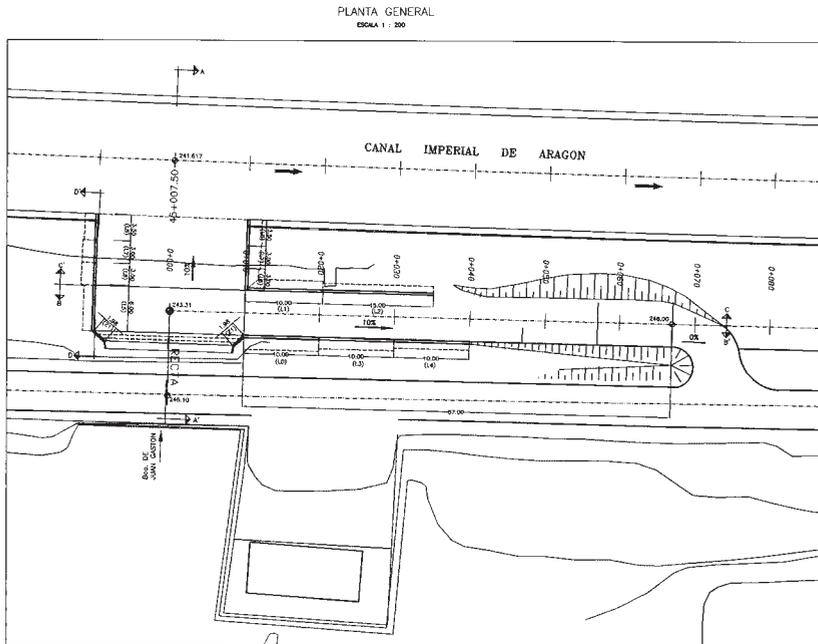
Proyecto de rampa-varadero y dársena (planta).
